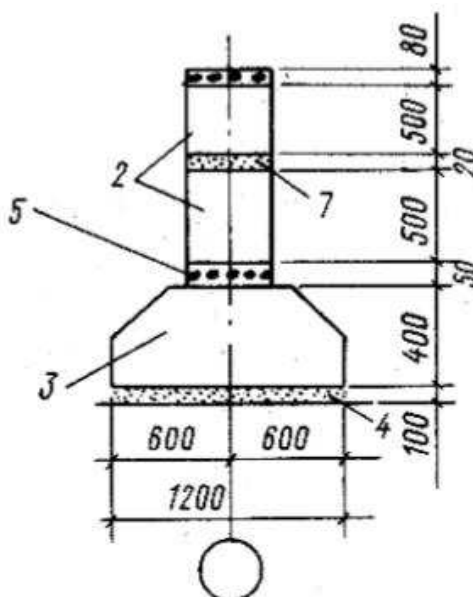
Схема сборного ленточного фундамента под стены здания
